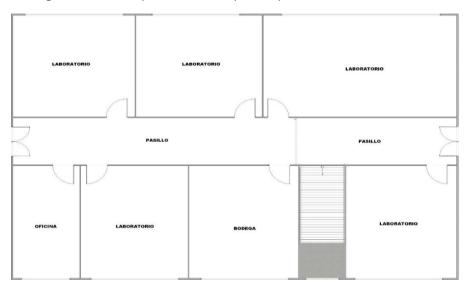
Diseño arquitectónico de la primera planta del Edificio de la UAIC
